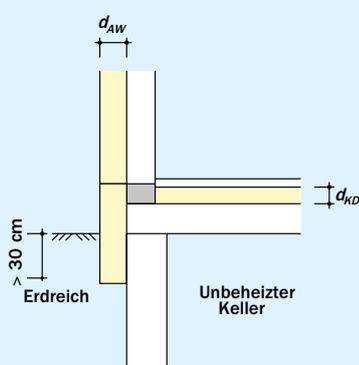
Konstruktionszeichnung aus KS-Detailsammlung, Detail 2.2.3
